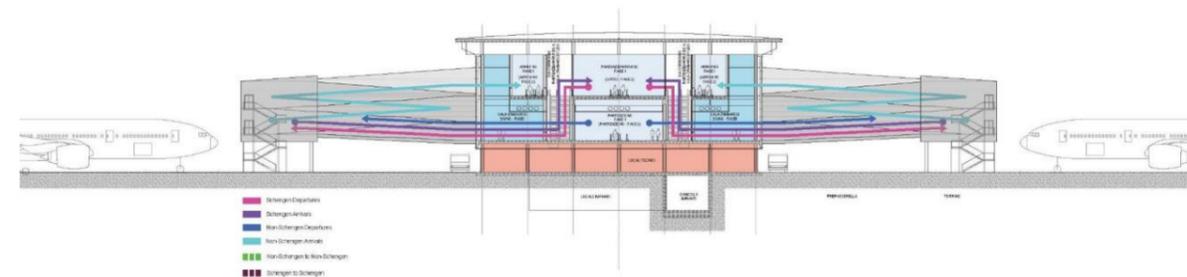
Sezione trasversale dell'area imbarchi sud
